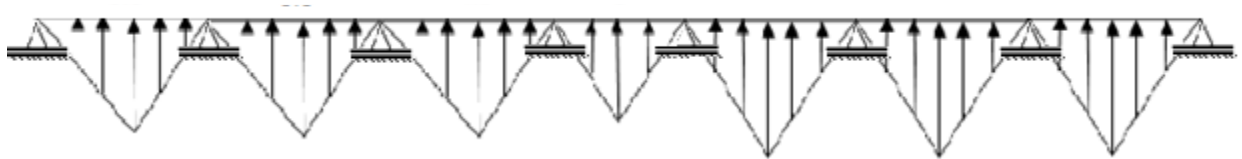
Distribution des charges sur les poutres secondaires
